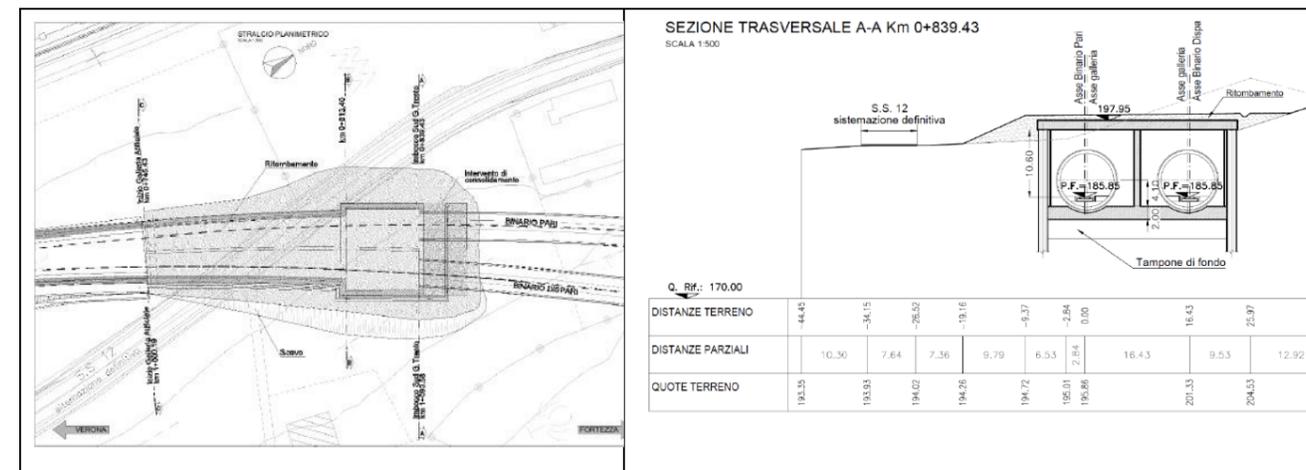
Stralcio planimetrico imbocco sud e Sezione trasversale
